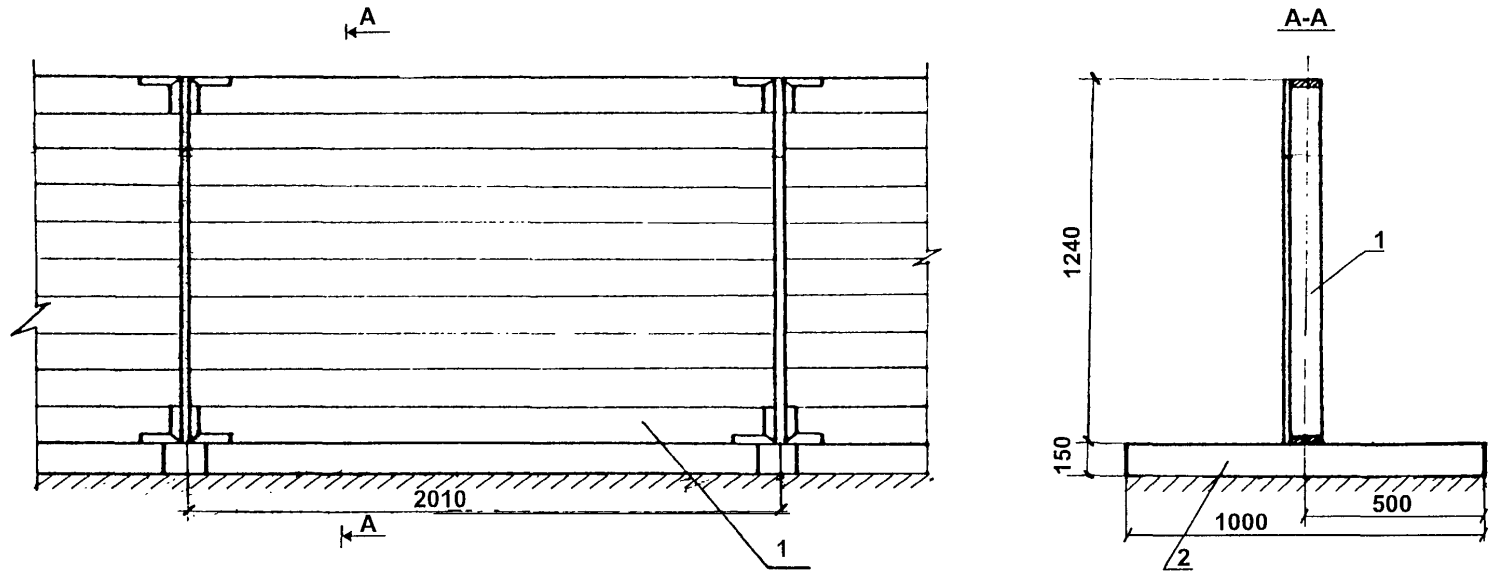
Сборно-разборное, бесстоечное ограждение на железобетонных лежнях:
